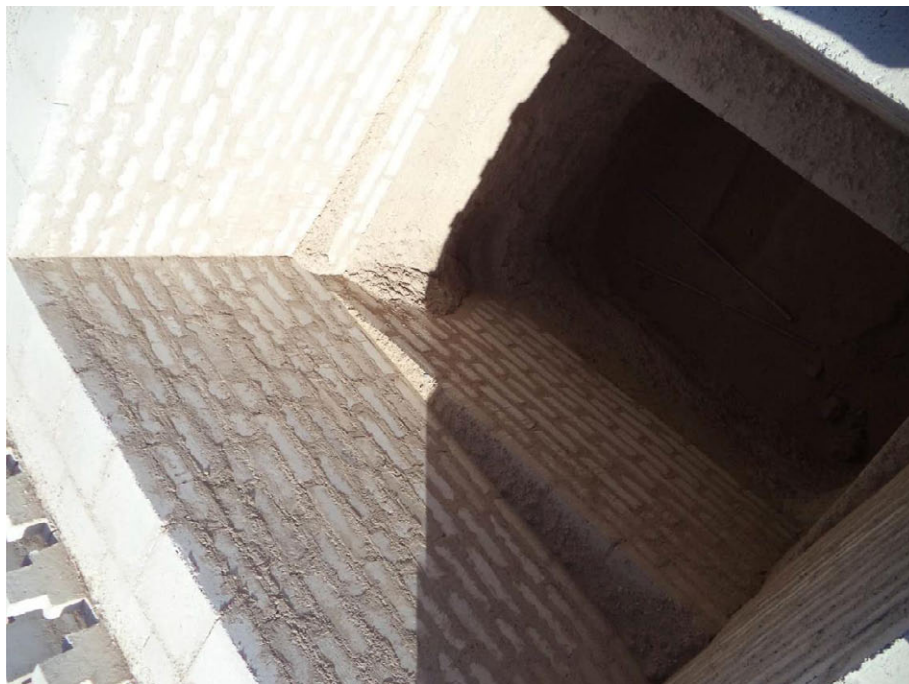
Fotografía Fase Constructiva. Detalle 2. Interior Torre Tumba 013.
